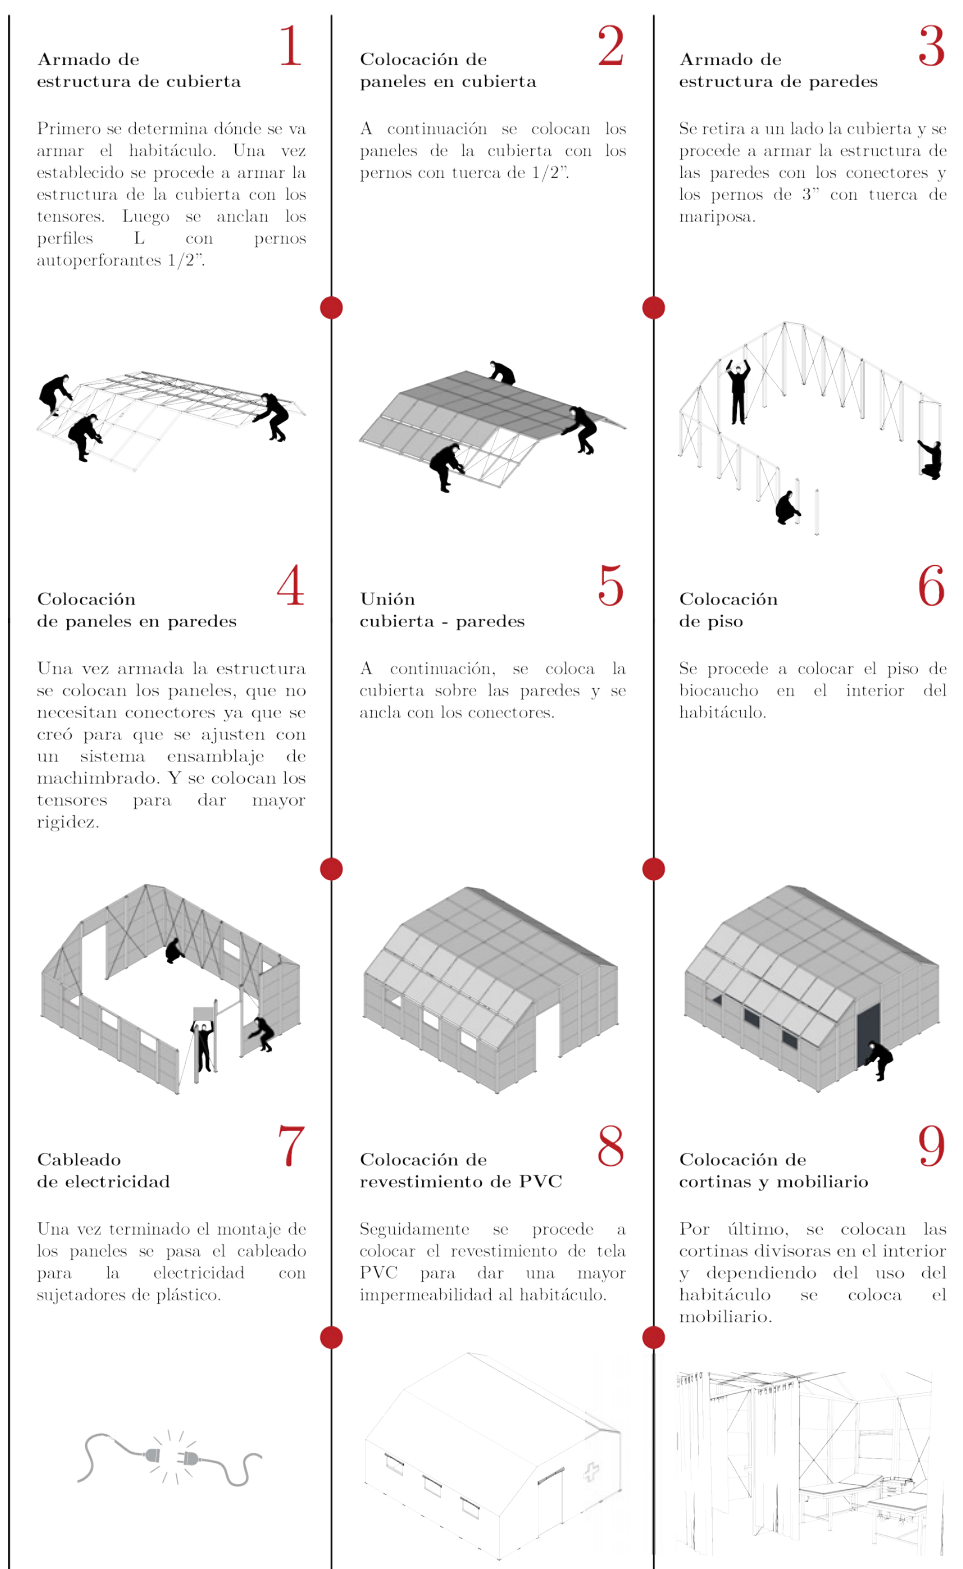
Montaje del habitáculo Modular Emergency Plant. Fuente y elaboración: Autores.
